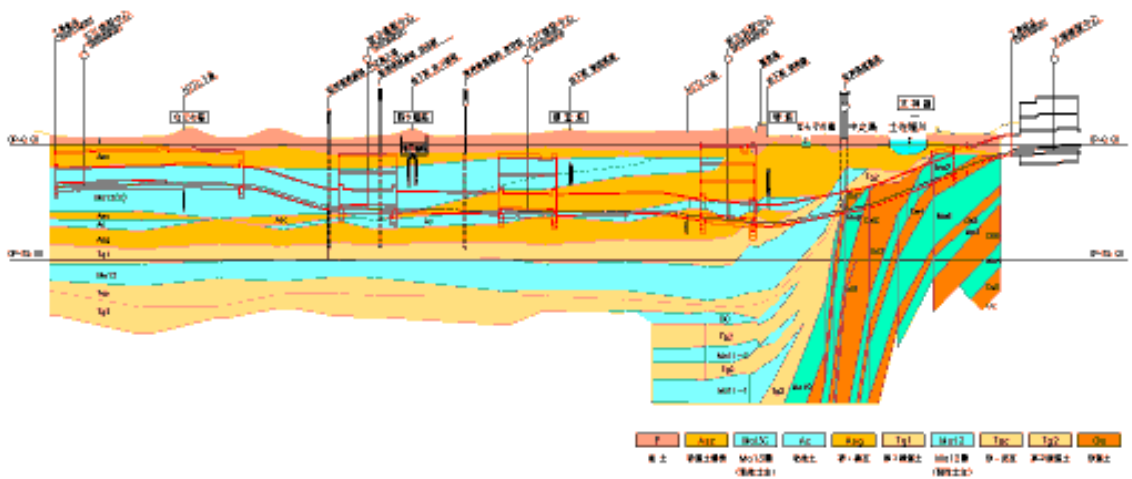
地質モデルより作成した地盤モデルと施工区間の図
